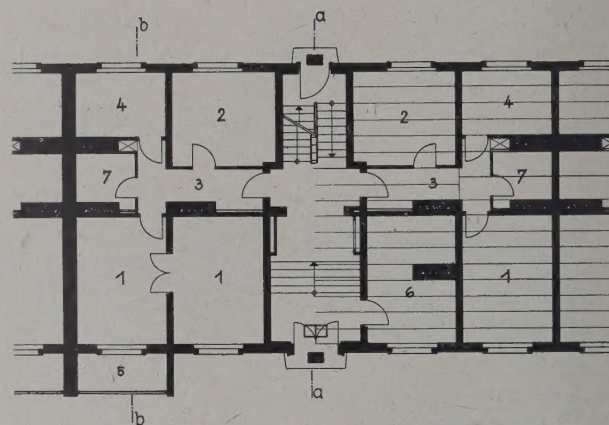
Erdgeschoßgrundriß mit einer Zwei- und einer Dreizimmerwohnung
